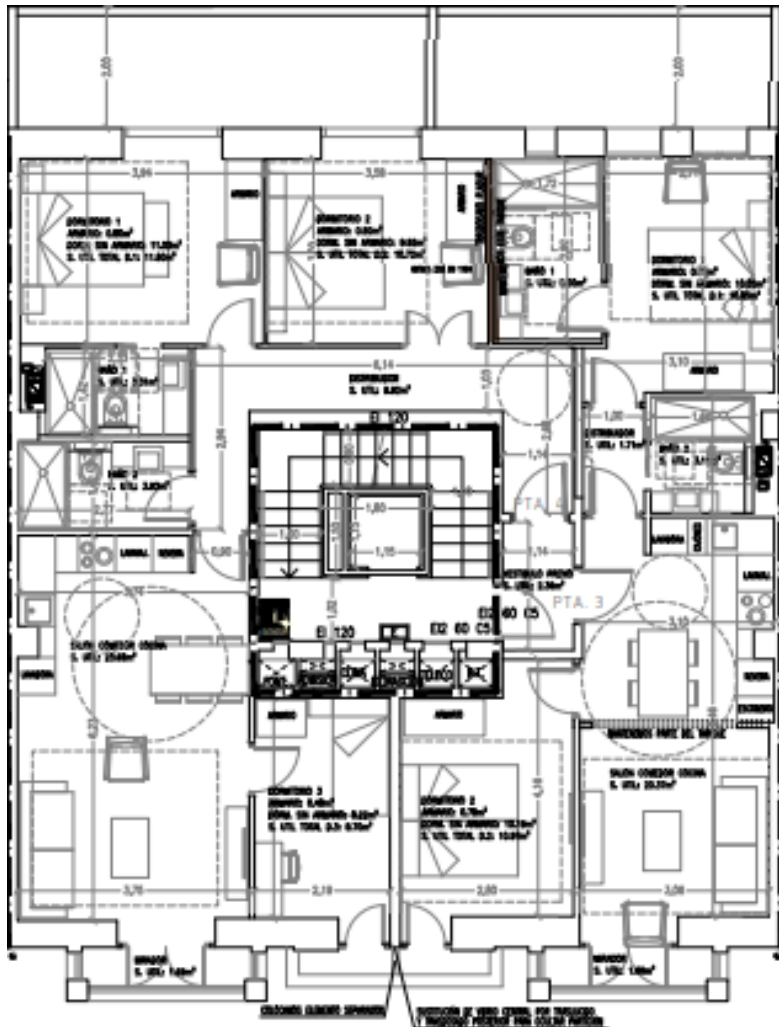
Estado reformado planta 2. Fuente: Creación Propia
